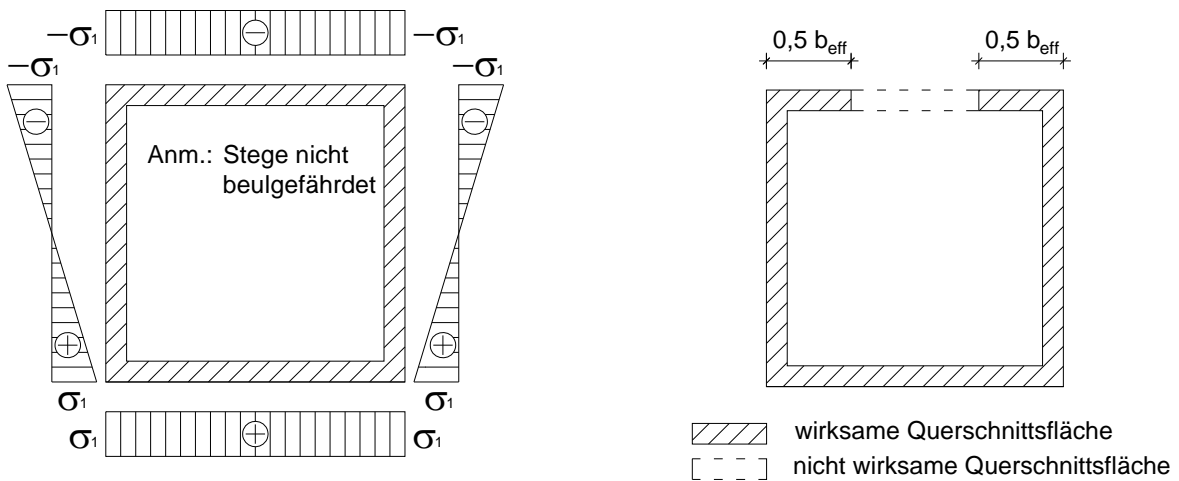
wirksame Querschnittsfläche für geschweißten Hohlkasten unter Druck- und Biegebeanspruchung, a) Bruttoquerschnitt mit Spannungsverteilung, b) wirksame Querschnittsfläche
